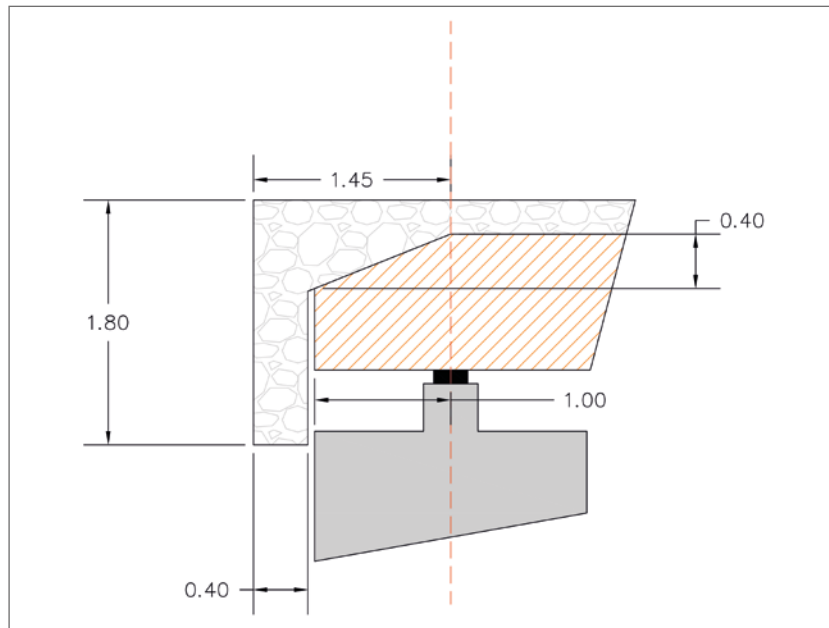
Détail de la retombée de dalle et du gousset de raidissement
